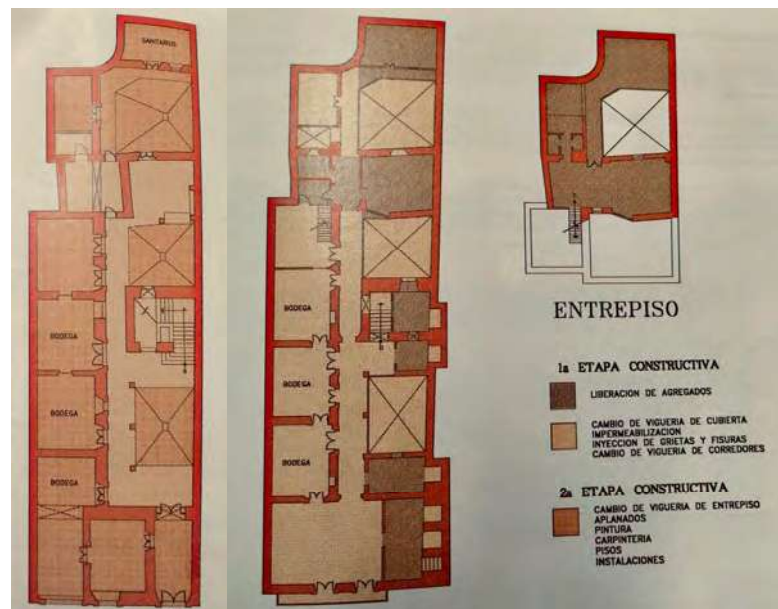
Plantas arquitectónicas antes de la primera intervención, se pueden observar conexiones hacia el teatro Ocampo. Fuente: Vargas Jaime, el monumento que volvió a nacer
